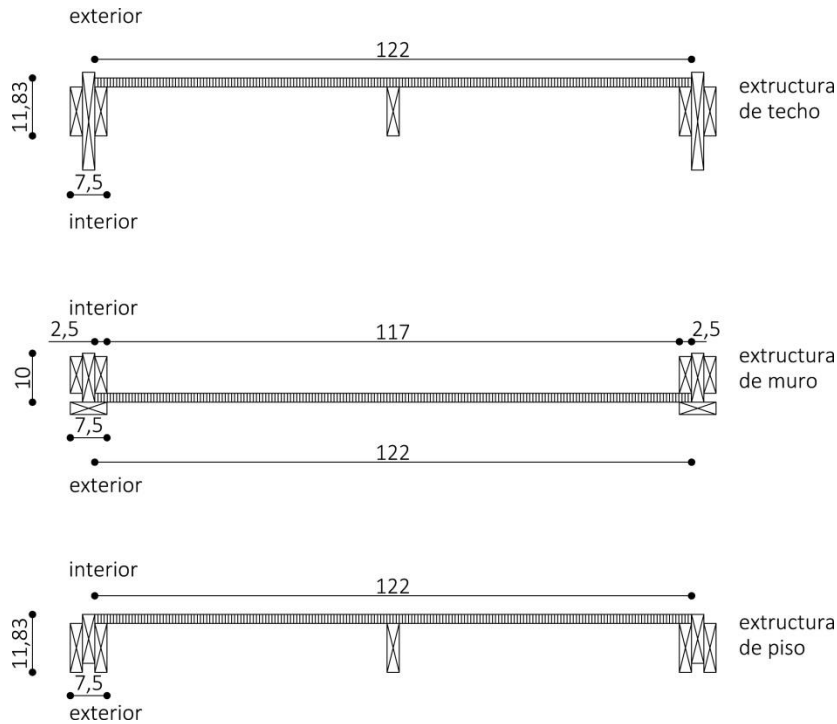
Detalles complejo de Techo – Muro – Piso para propuesta exploratoria
